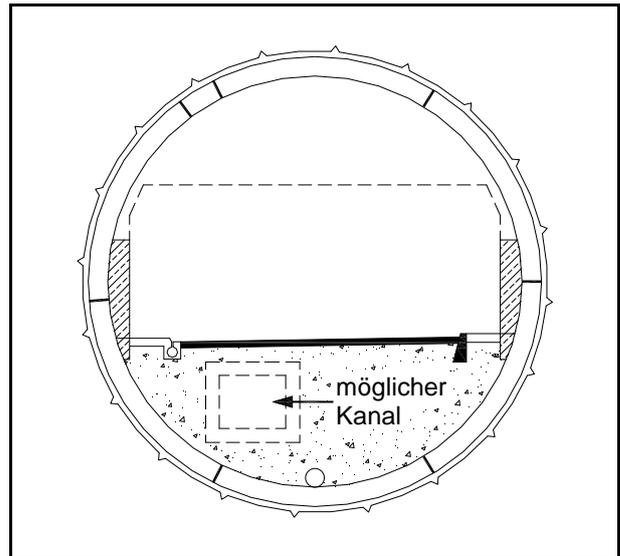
1-schalige Konstruktion mit Sohlauffüllung
